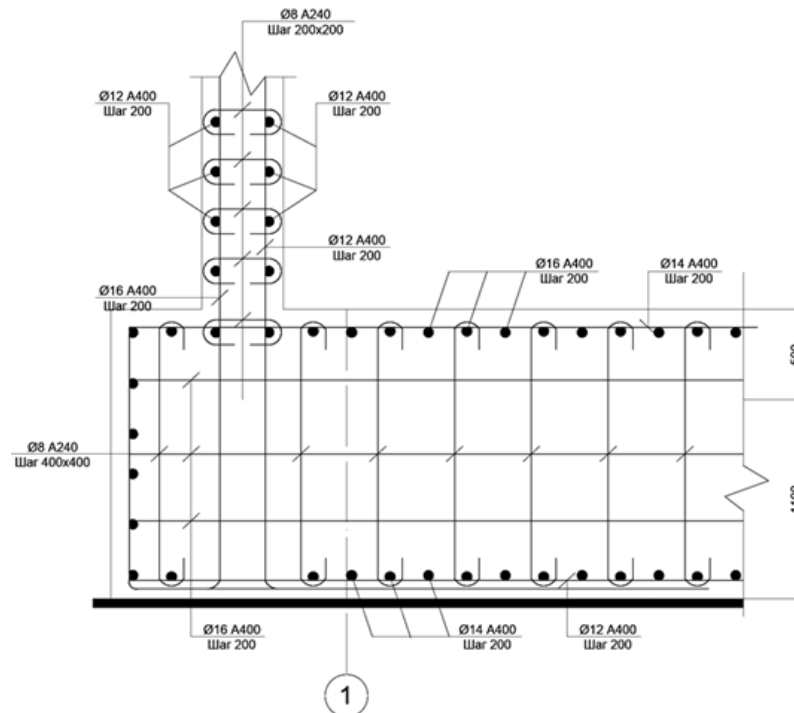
Узел сопряжения стены и дна с усиленным фундаментом с помощью арматуры
